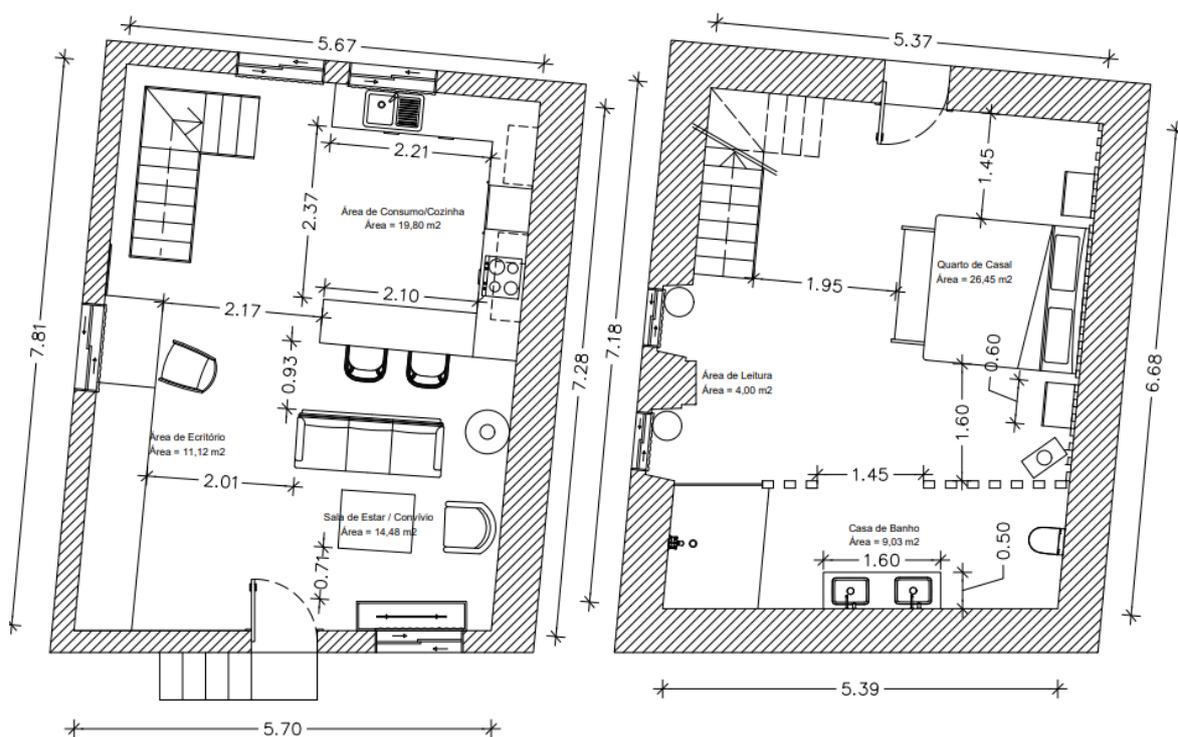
Planta cotada piso 0 e piso -1. Fonte: Maria Leonor.
